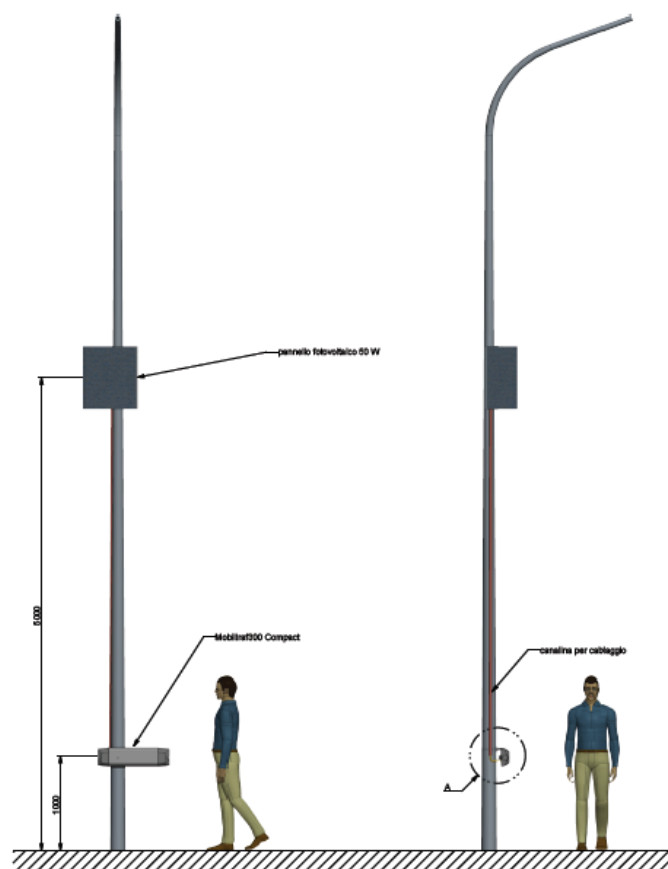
Schema tecnico di installazione su palo dell'illuminazione
